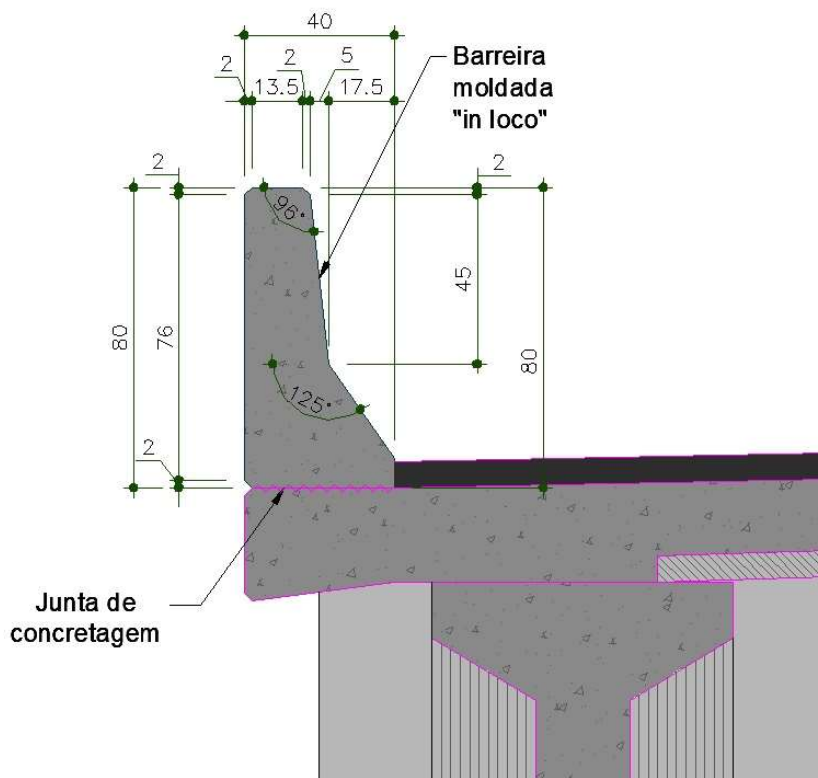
concepção da barreira e seu pré-dimensionamento.
